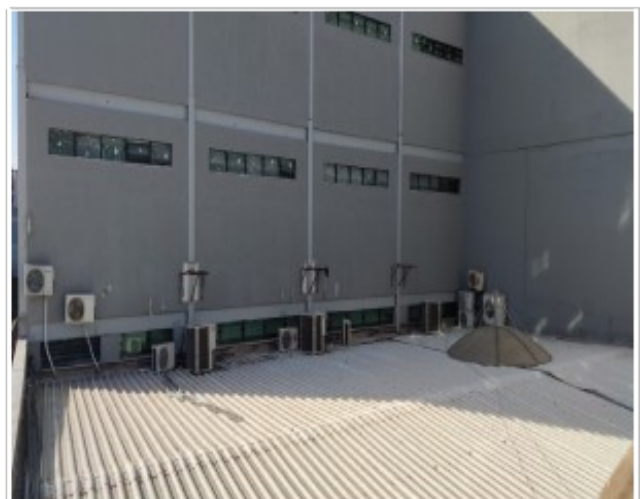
Telhado acima do plenários - serviço de substituição de calhas, rufos e limpeza.
